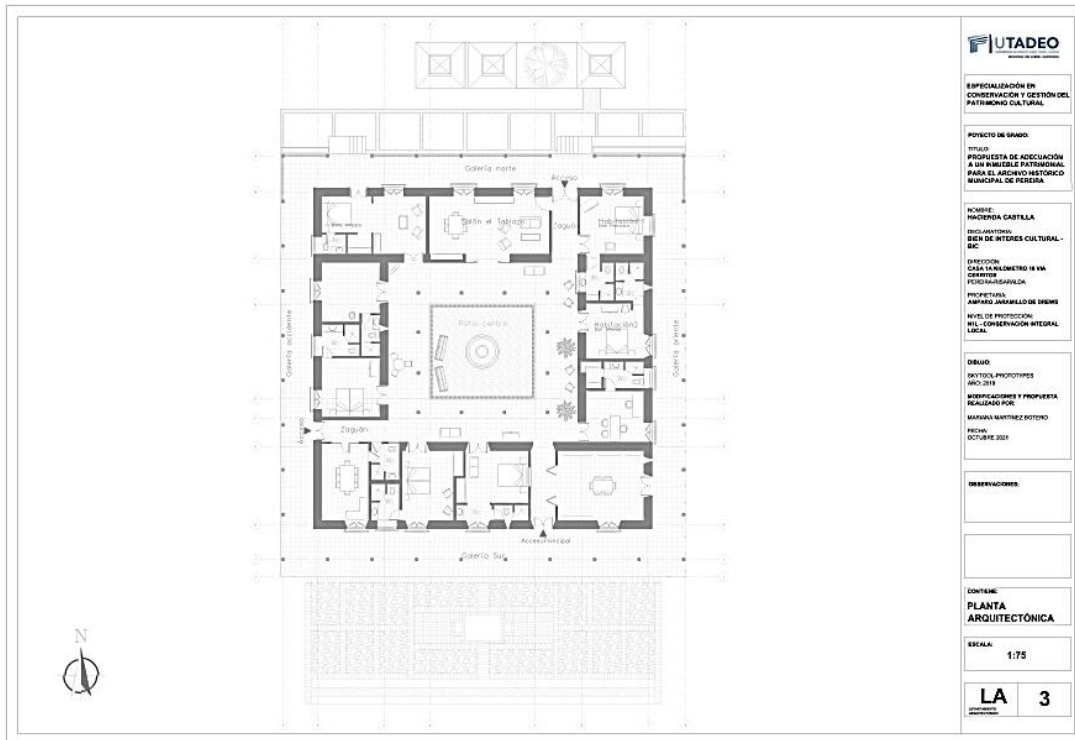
Levantamiento arquitectónico- Planta general. Fuente: Propia
